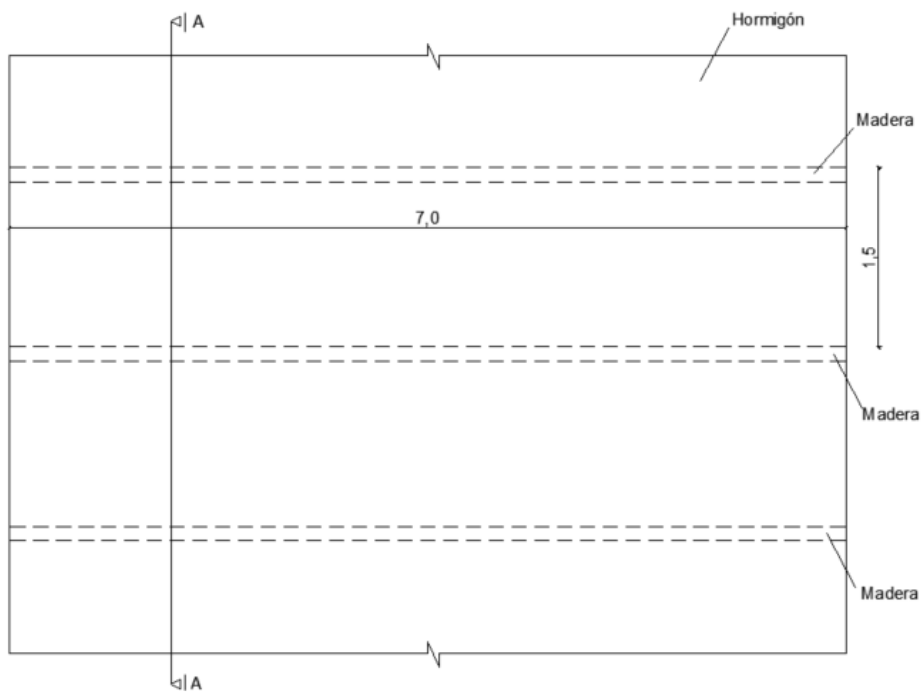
Vista en planta del entrepiso. Unidades: metros.
